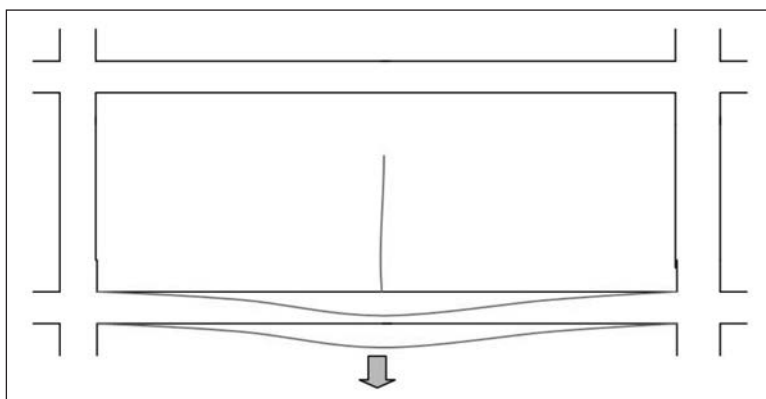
Fisuración vertical producida por deformabilidad de viga soporte
